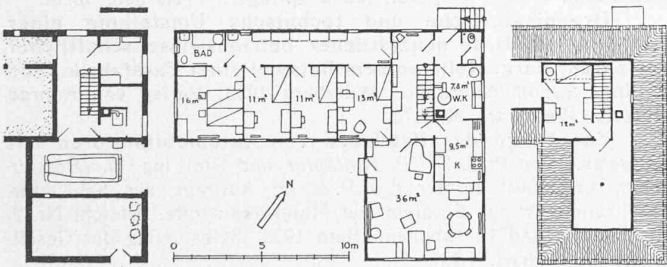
(unten). Grundrisse 1 : 400 von Keller, Erd- und Dachgeschoss.
